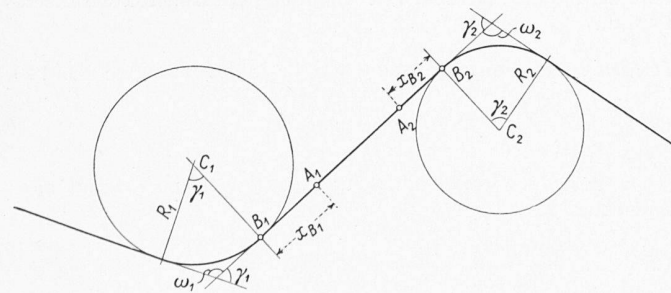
Grundtangente und Grundkreise der Linienführung, Orientierung
